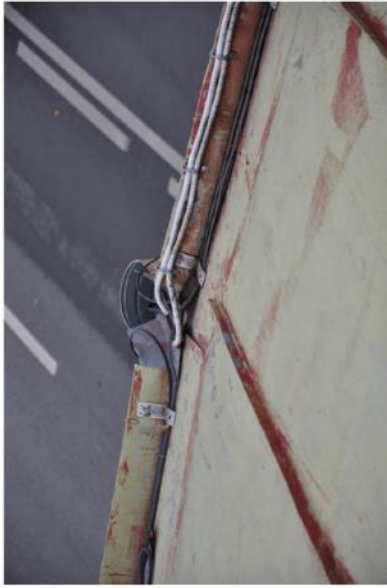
Конструкция системы подогрева карнизных свесов, водосточных труб. Следы коррозии металла (очаги ржавчины). Отслоение красочного слоя окрытия кровли.
